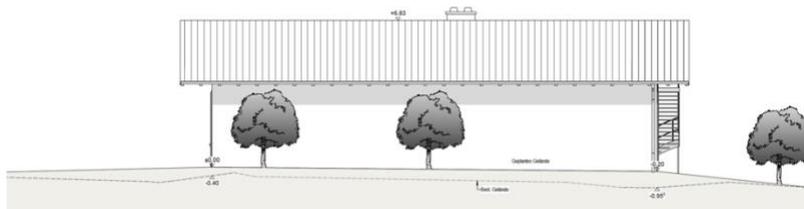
Ansichten Heizhaus, Planstand: Entwurfsplanung 16.12.22
